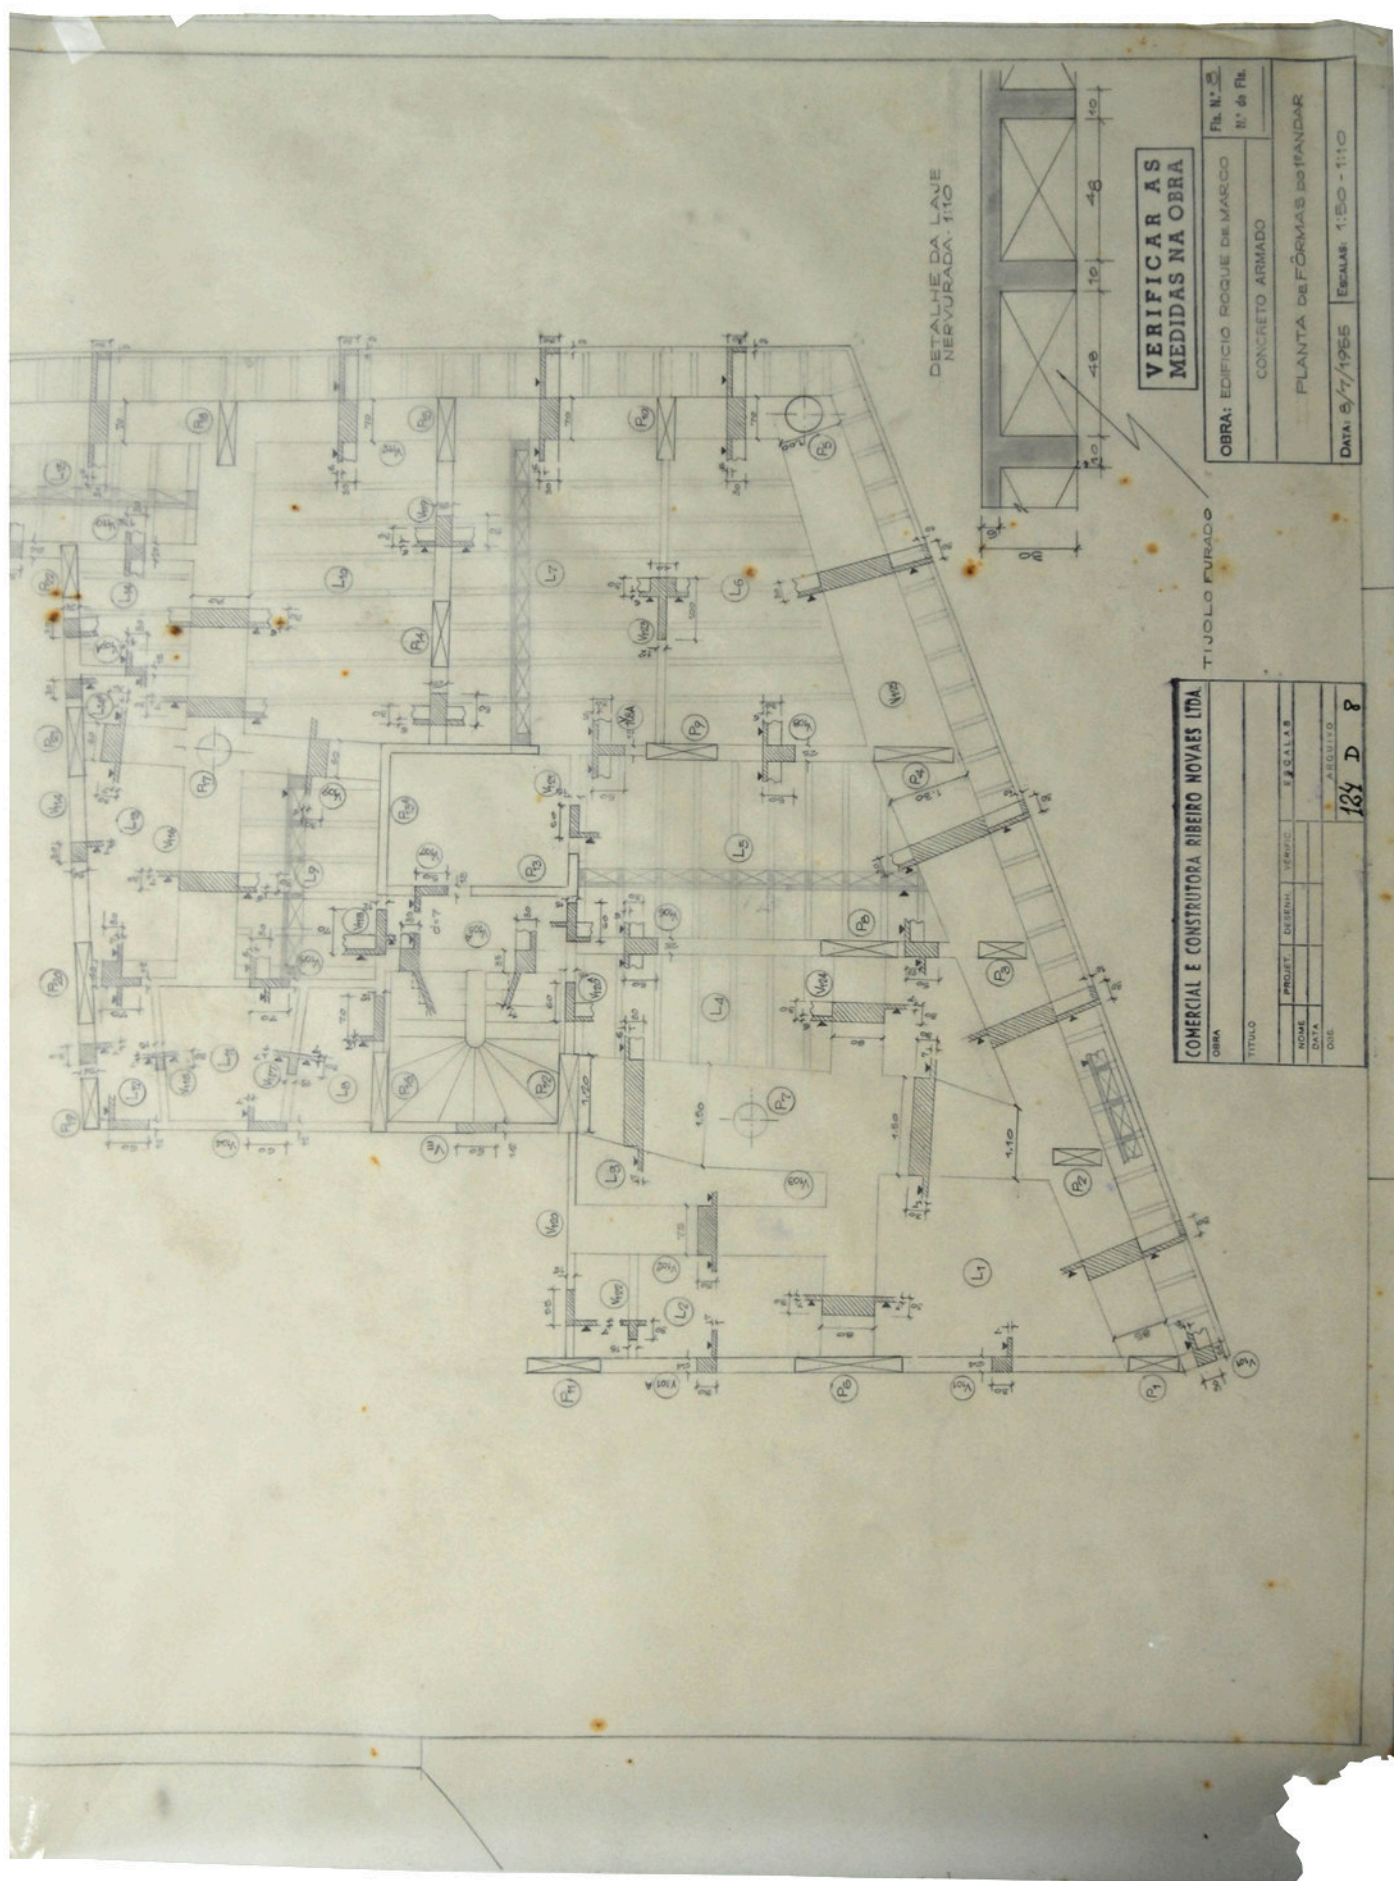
Planta de forma do primeiro andar do Edifício Roque de Marco. Observar laje nervurada preenchida com tijolos furados e altura de 30cm. Fonte: Arquivo do Engenheiro Noyr Rodrigues.
